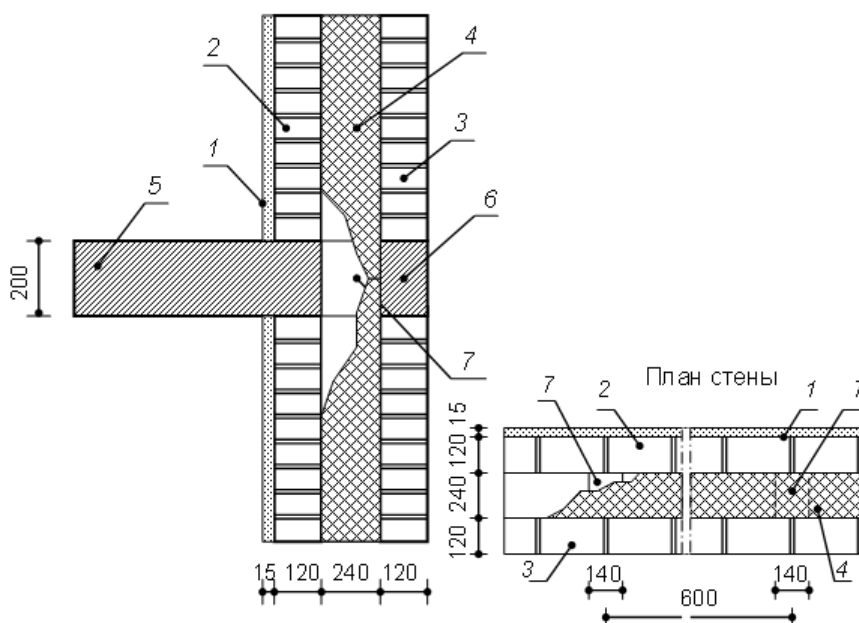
Узел сопряжения плиты перекрытия с наружной стеной:
